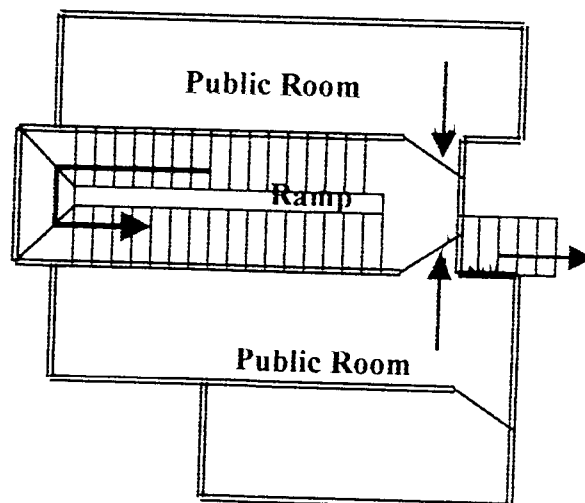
Lokasi Ramp di Samping Bangunan Terminal
